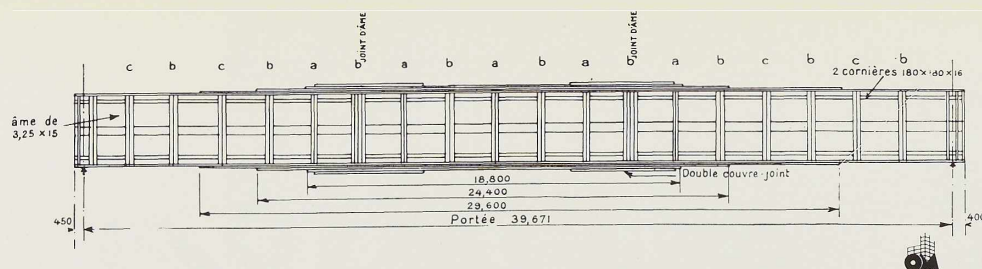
Schema d'une poutre principale du pont dit de Louvain à Charleroi.
